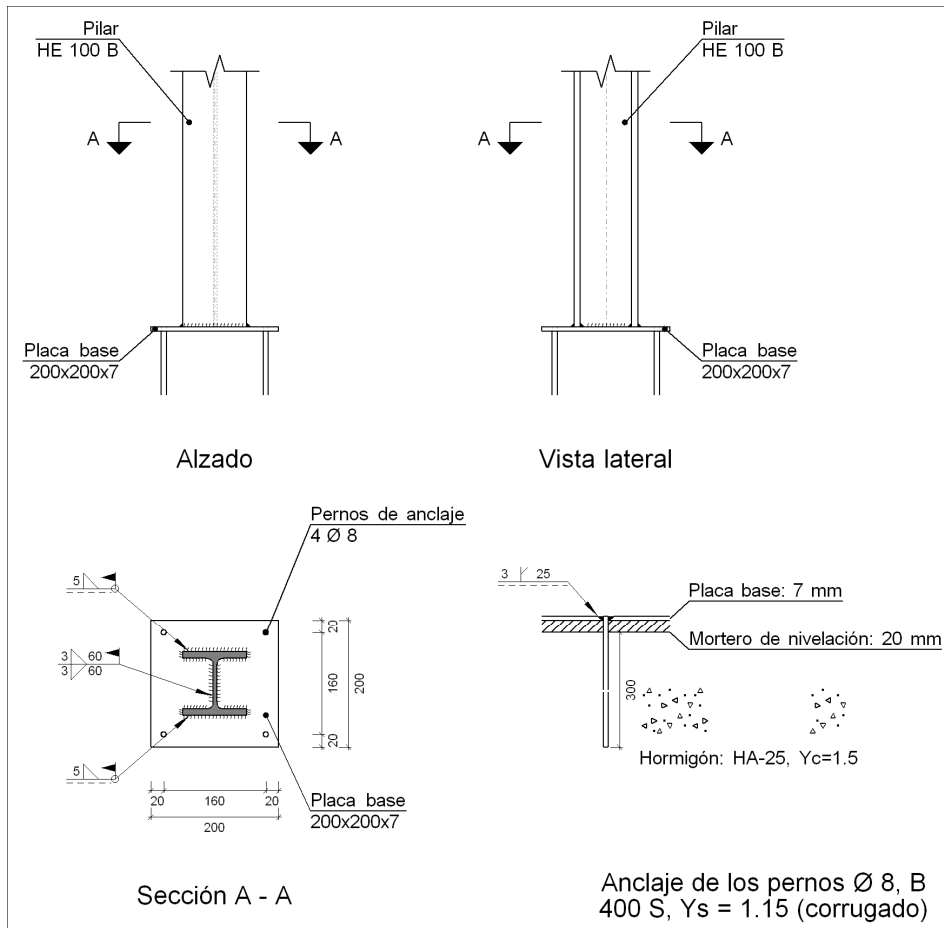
Detalle de los pernos de anclaje de la estructura inferior de las escaleras
